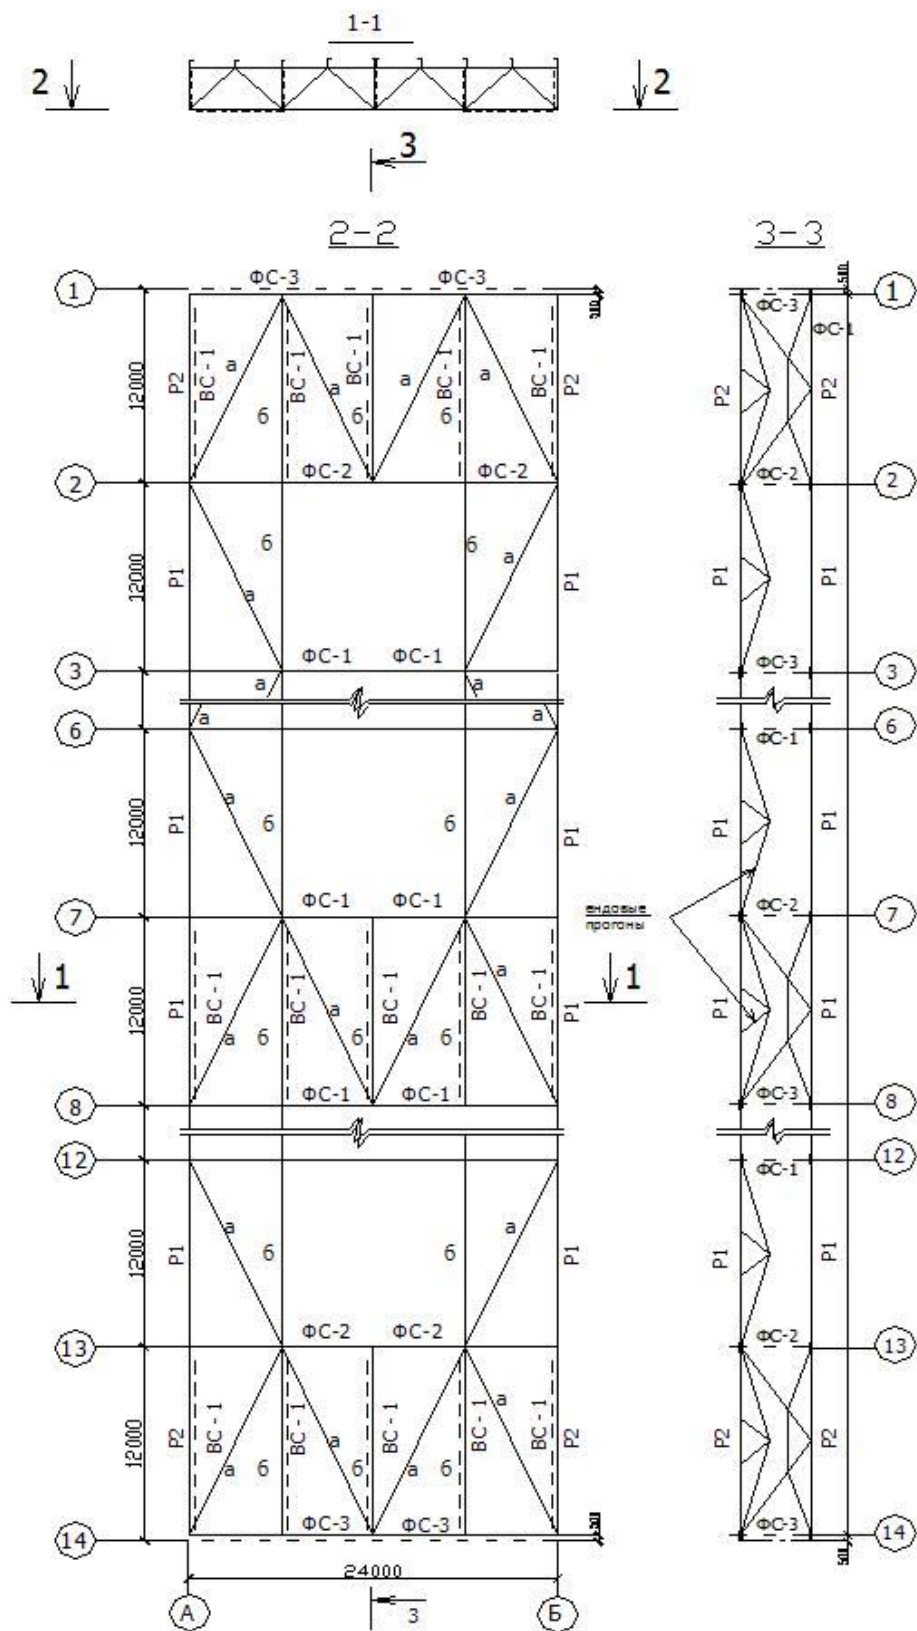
План связей по нижним поясам и вертикальные связи между фермами
